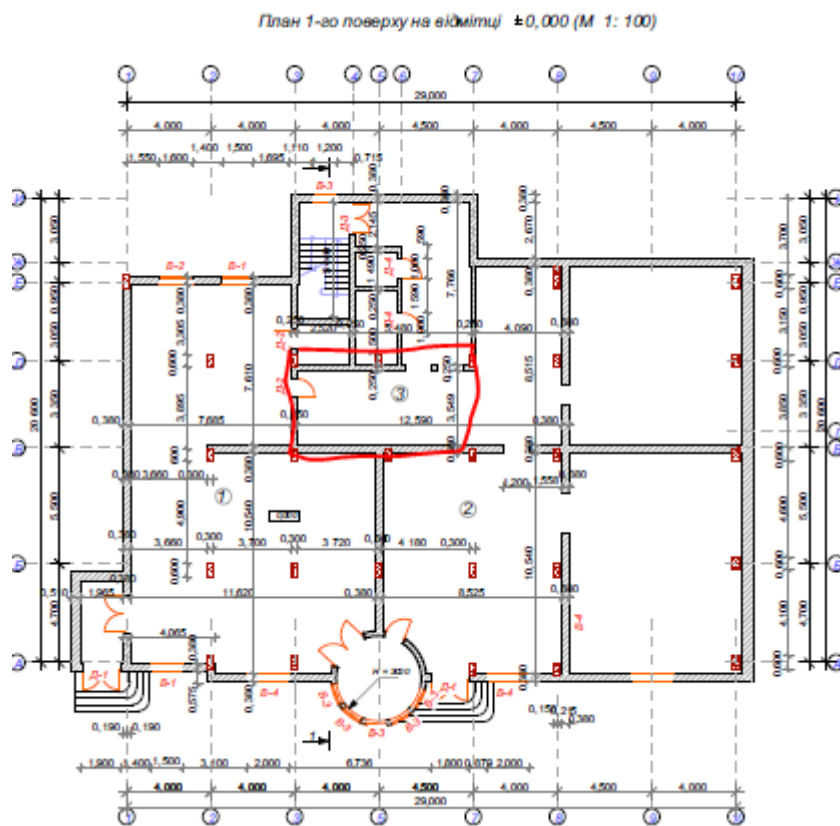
План захисного приміщення розташованого на першому поверсі
